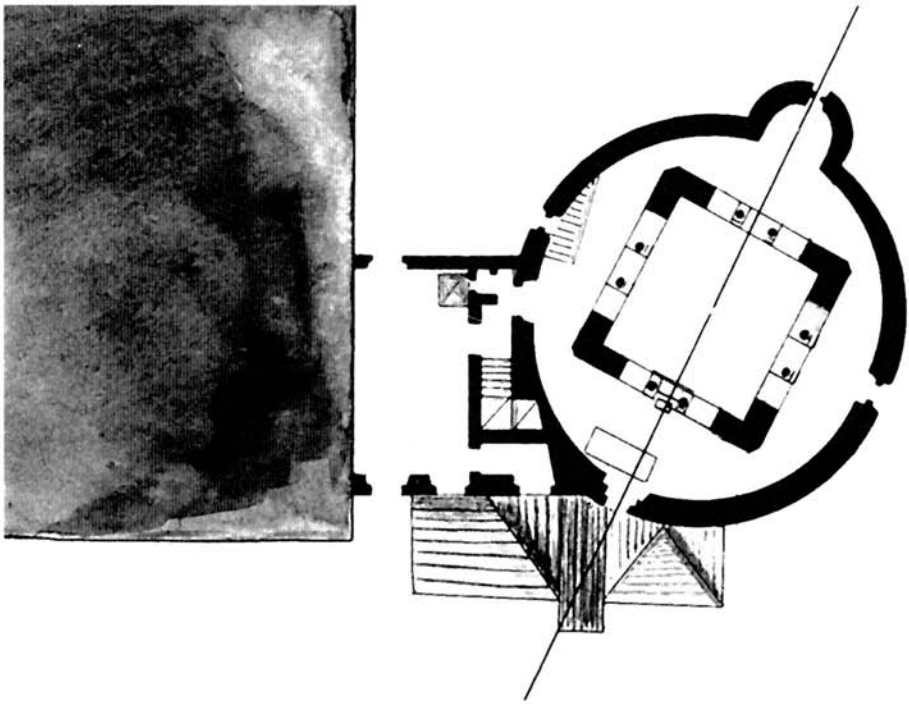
Thomaskapelle Grundriß Obergeschoß (Plan Joseph Hillebrandt 1804 Landesarchiv).
